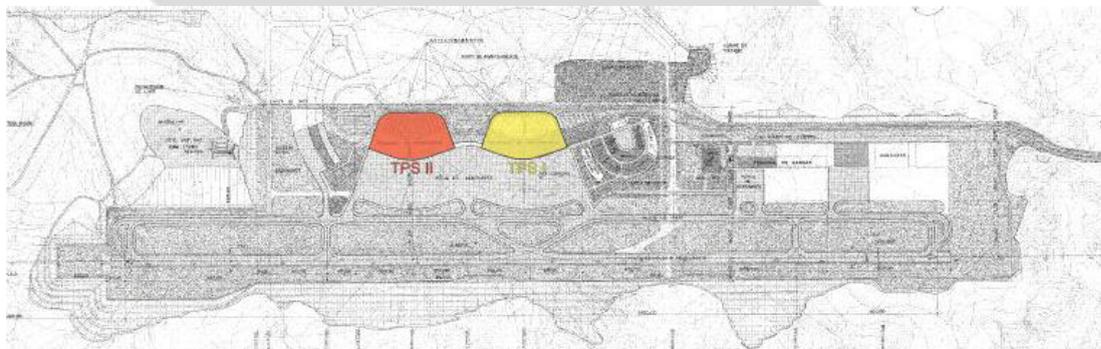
Planta de Situação do TPS II - Fonte: EIA (FIGUEIREDO FERRAZ. Plano Diretor do Novo Aeroporto de Belo Horizonte, 1981).
